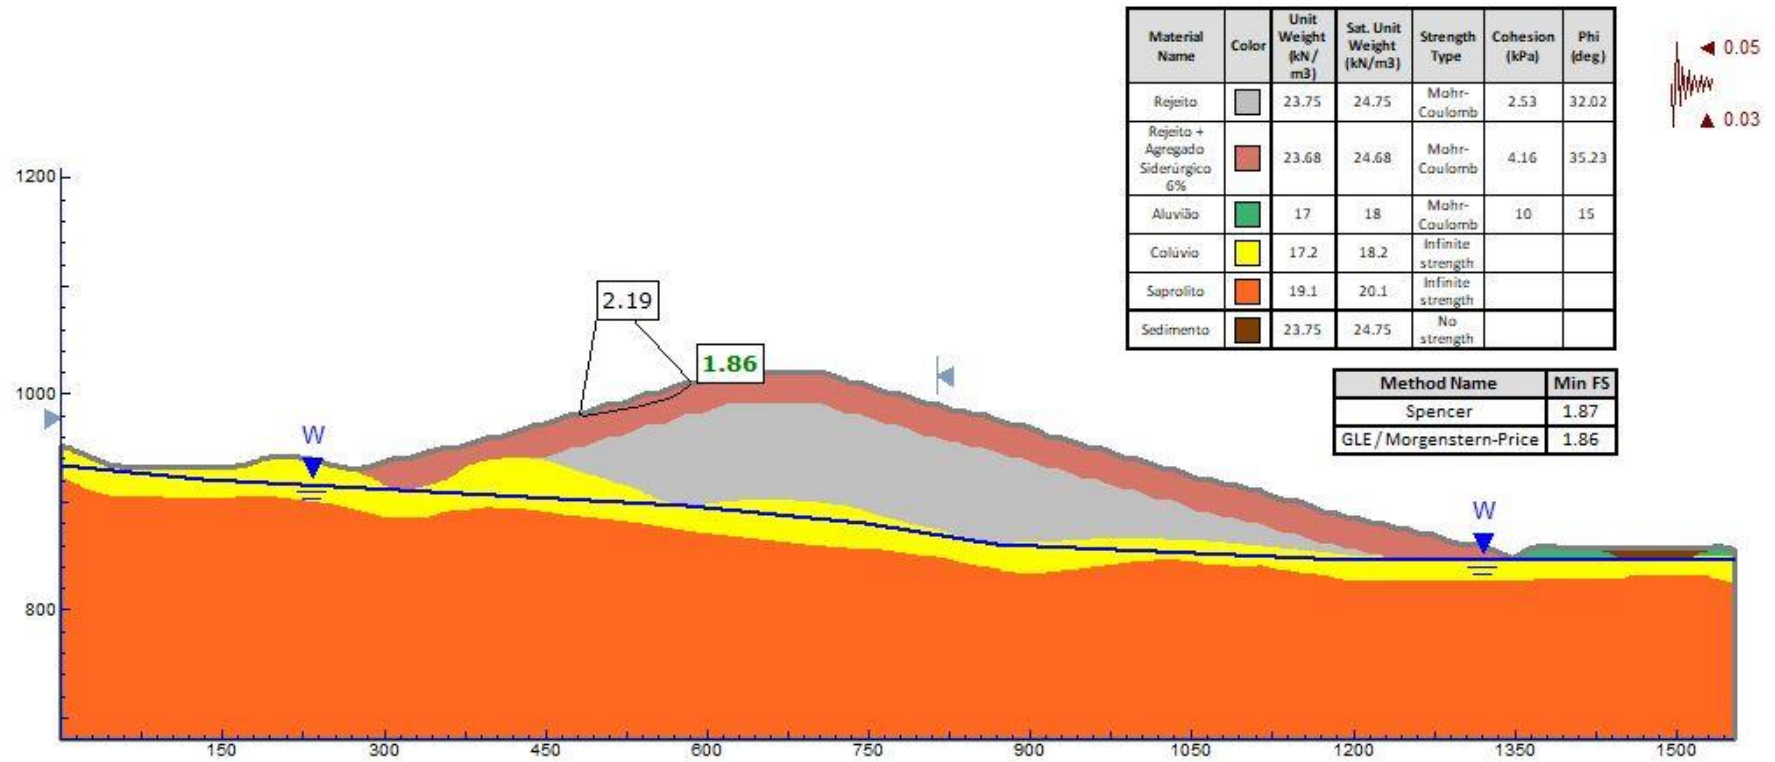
Análise de estabilidade – Rejeito + 6% de agregado siderúrgico – Pilha de 172 m – Face da pilha com utilização de aditivo – Pseudoestática – Talude direito
